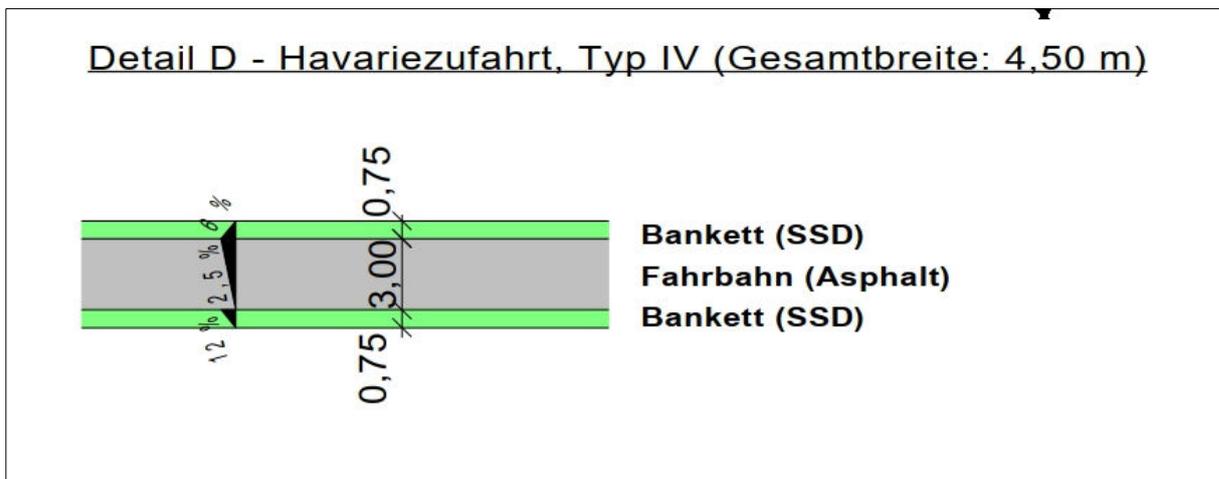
Geplanter Querschnitt der Havariezufahrt
